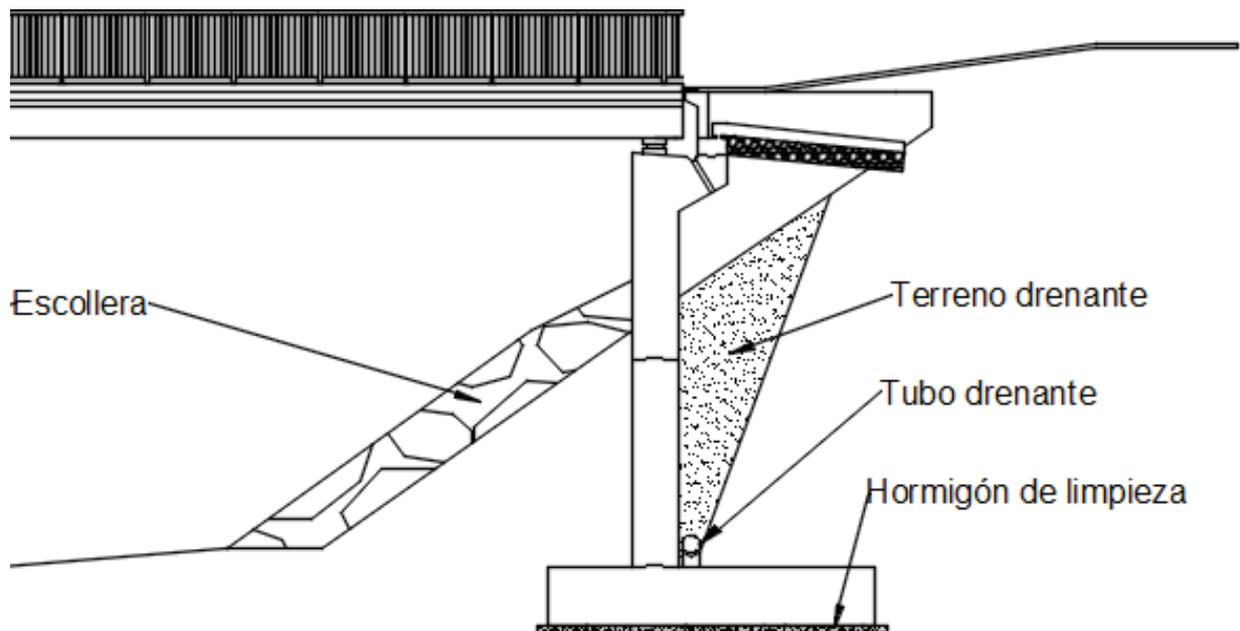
Corte del estribo y el terreno, detalle del drenaje del trasdós.
